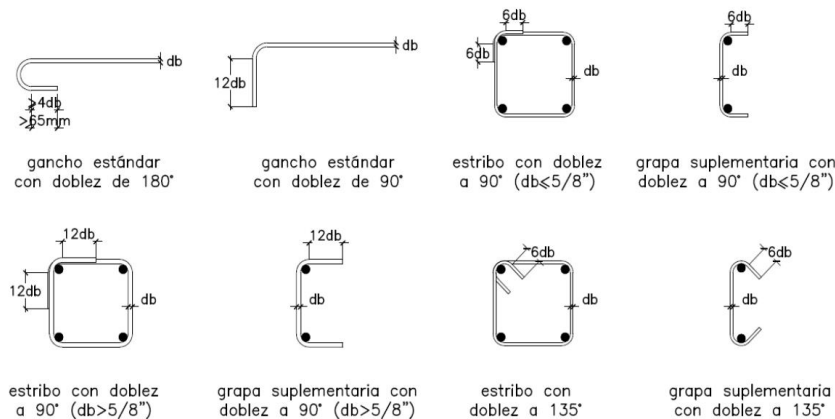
En la norma E 0.60 del capítulo 7 “Detalles del refuerzo” en la sección 7.1 “Ganchos Estándar” en la Fig. 7.1 “Ganchos de barras longitudinales, estribos y grapas suplementarias”
